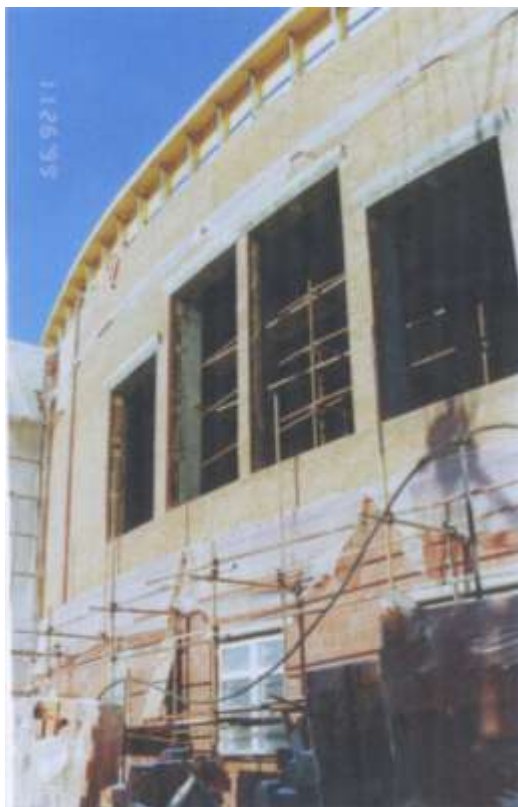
Строительство здания англо-американской школы с наружными стенами из кладки с гибкими связями, Москва, 1999 г.
